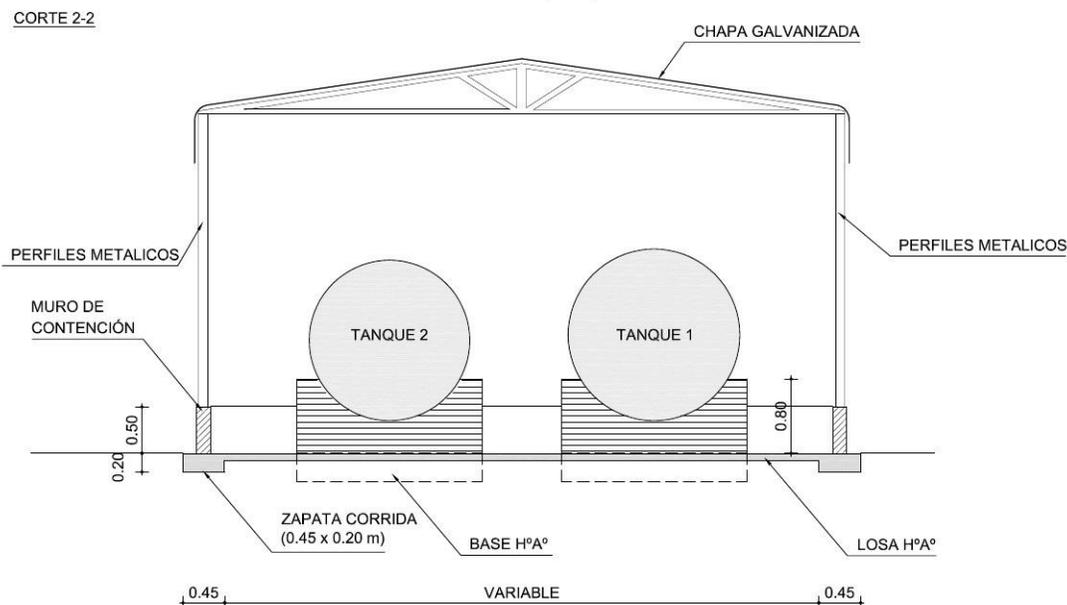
Tanques horizontales y su pileta de contención techada
